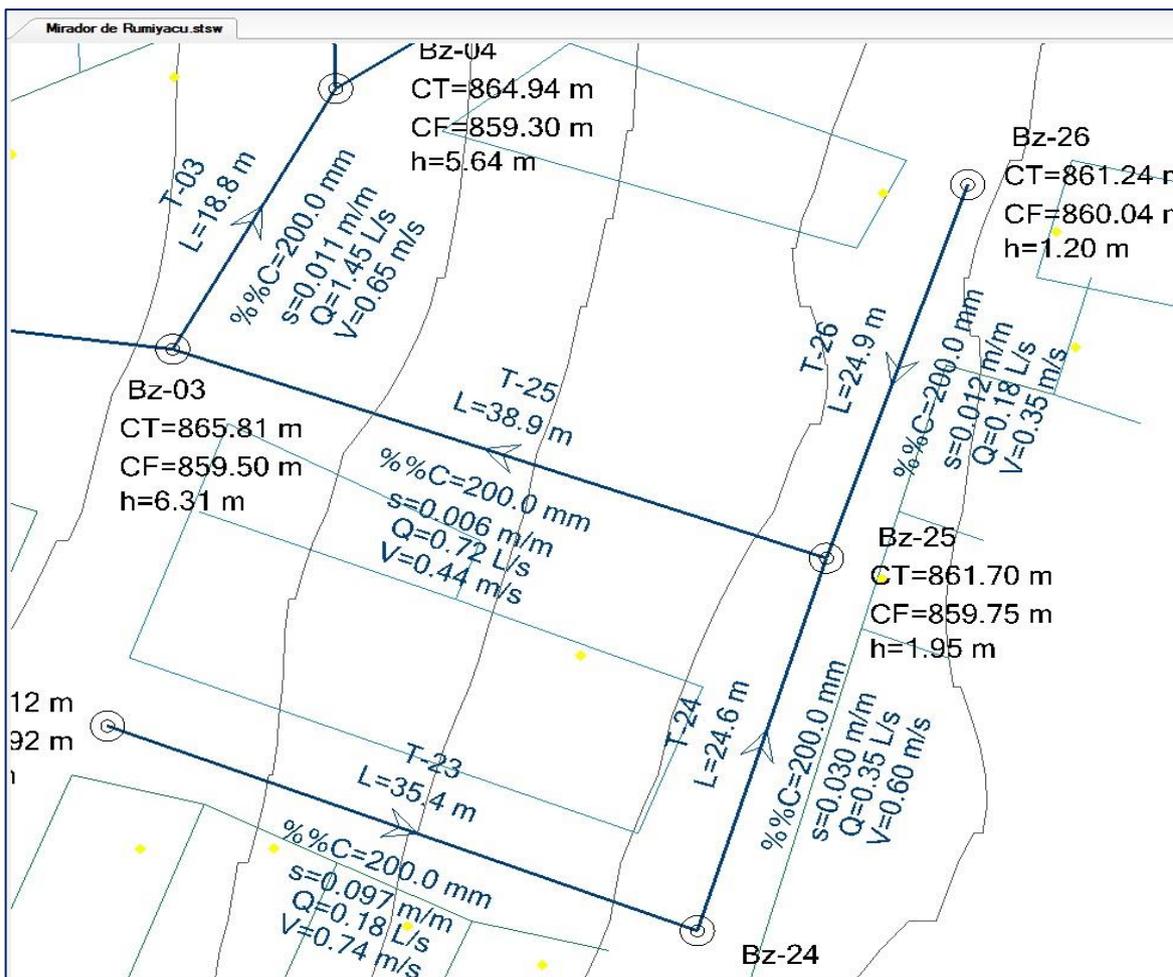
Vista de planta del buzón 25 al 03. (Fuente: Software SEWERCAD).
